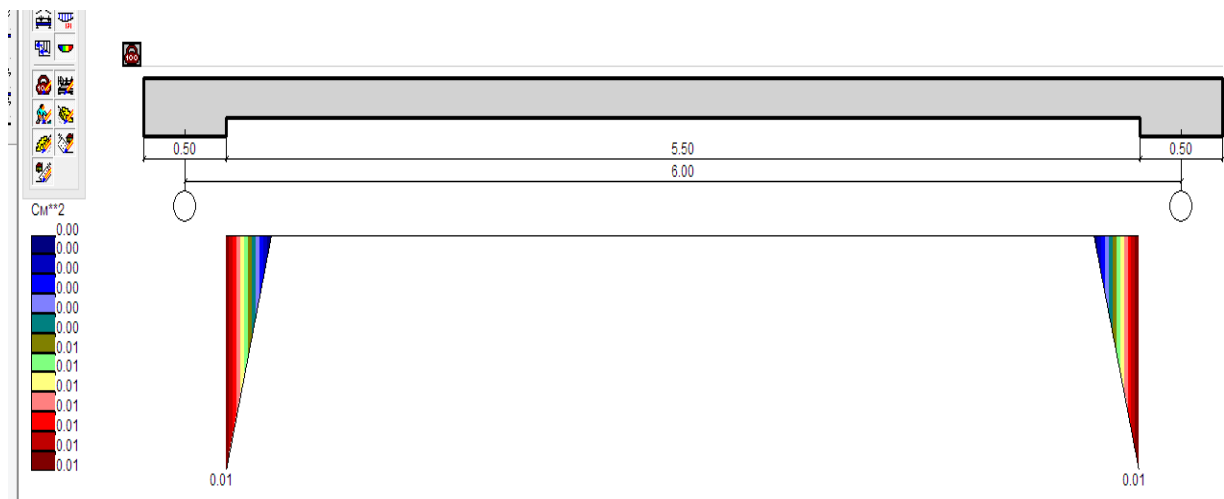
Схема підбору та розташування поперечного армування балки
